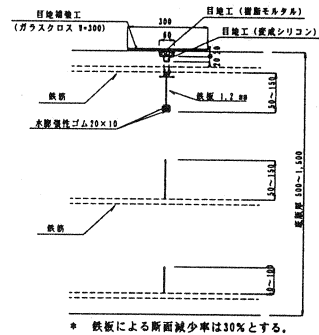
底版外円部ひび割れ誘発目地詳細図
